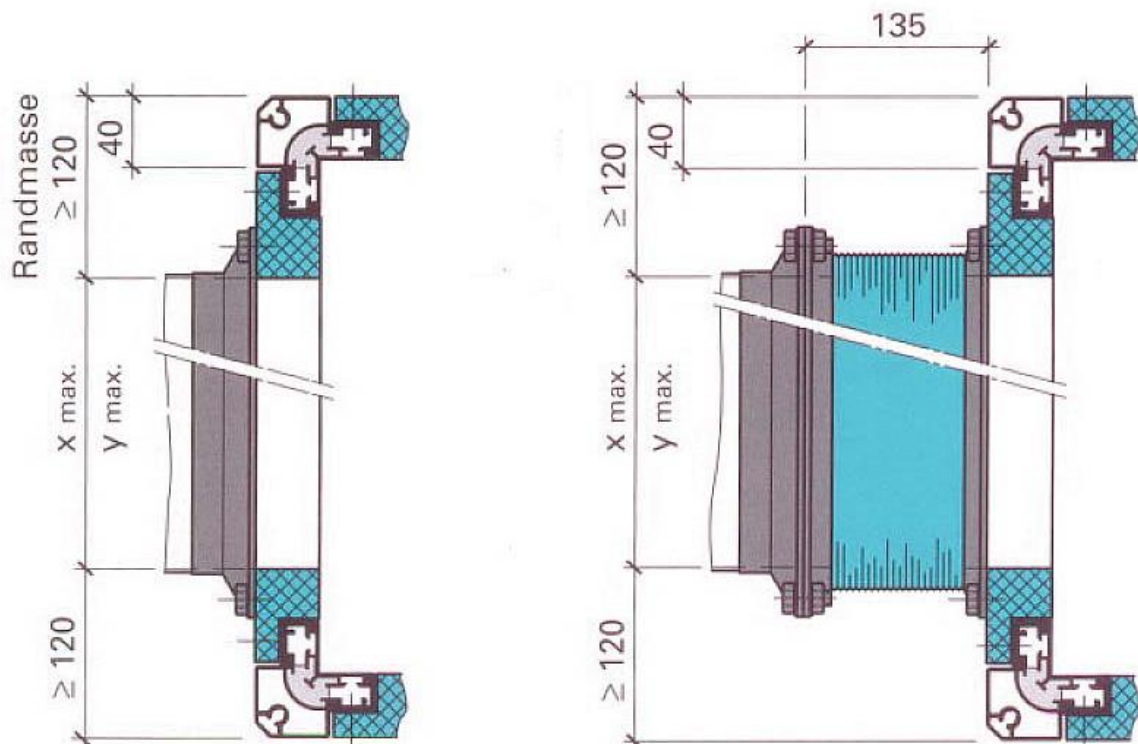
Ausführungsvarianten für Kanalanschlüsse
